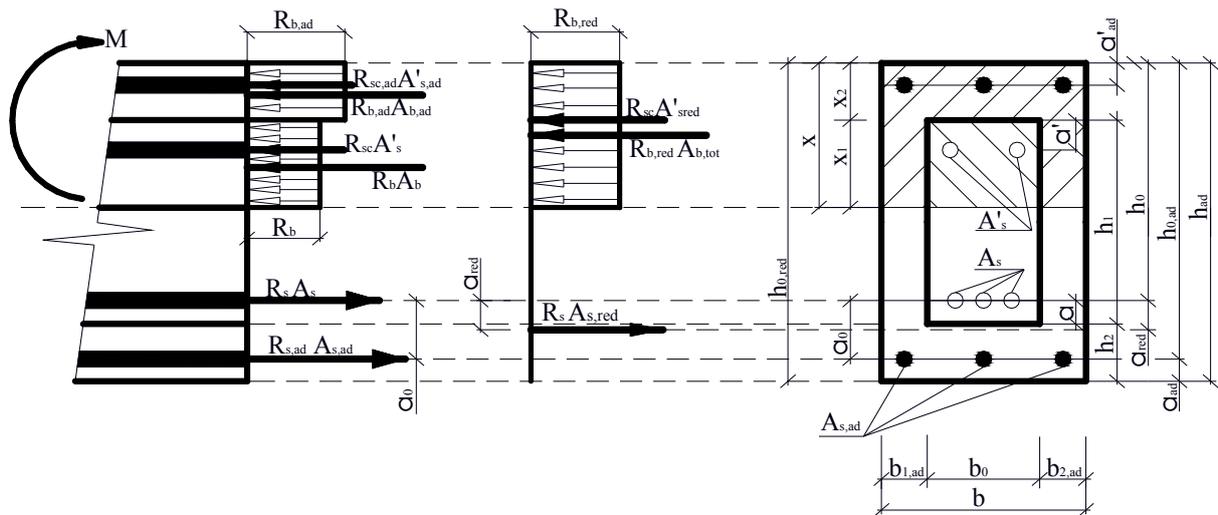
Расчетная схема и эпюры напряжений в нормальном к продольной оси сечения изгибаемого элемента, усиленного облоймой (общий случай)
